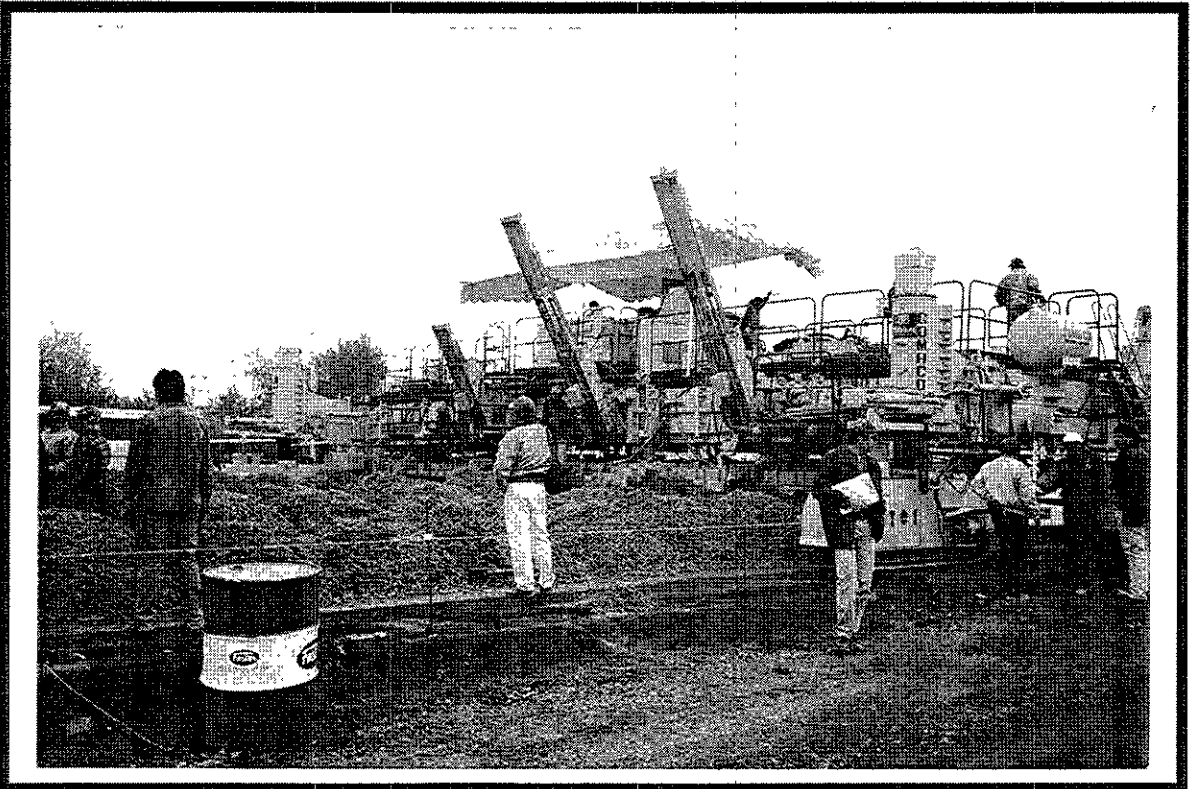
En esta pavimentadora, el acero para transmisión de esfuerzos se coloca mediante gatos hidráulicos montados sobre las guías metálicas para hincado, localizadas al frente de la pavimentadora.
